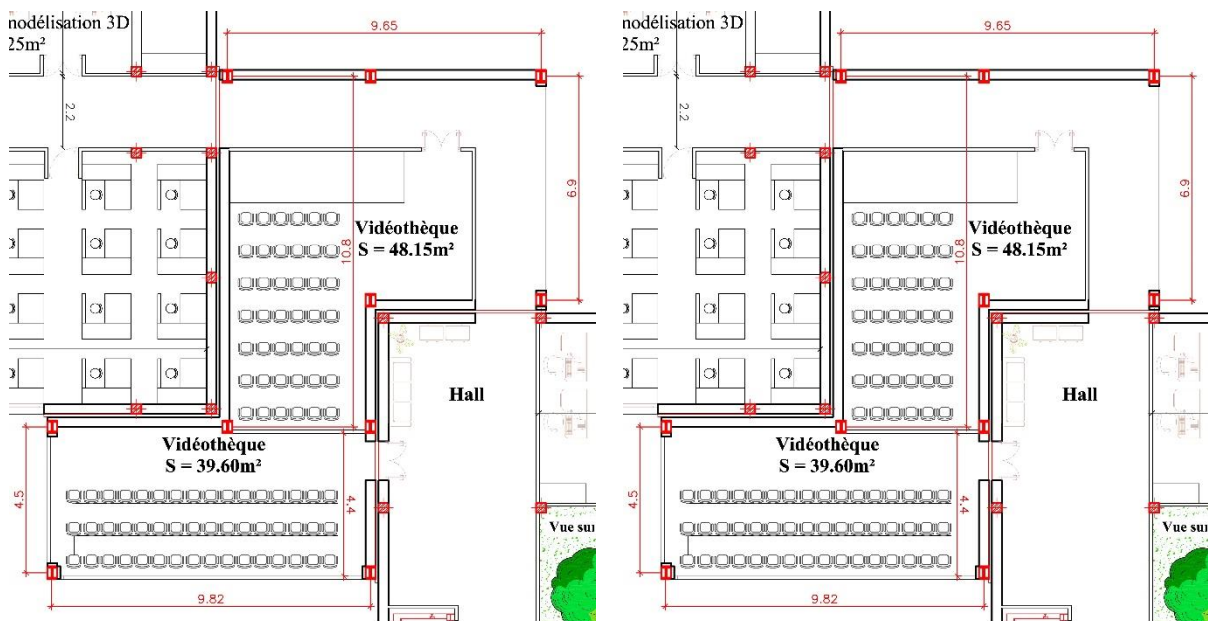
Plan et Structure de la vidéothèque (poutre métallique alvéolaire).
